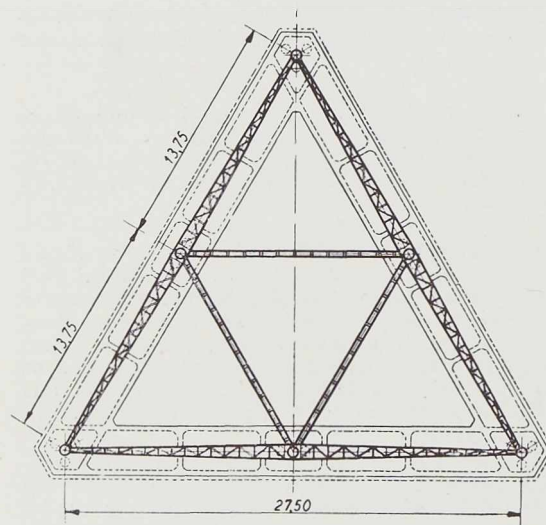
Section transversale du projet de pylône entre les cotes 0.00 et 83.50.
